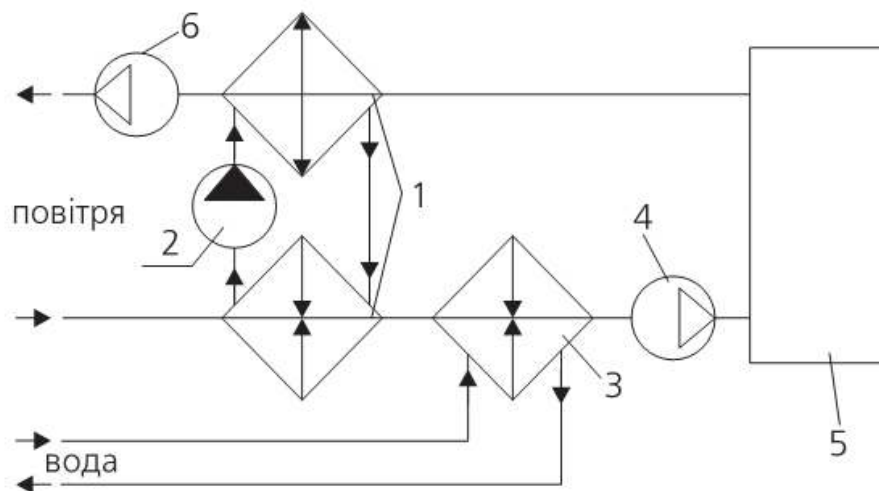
Принципова схема системи вентиляції з проміжним теплоносієм
